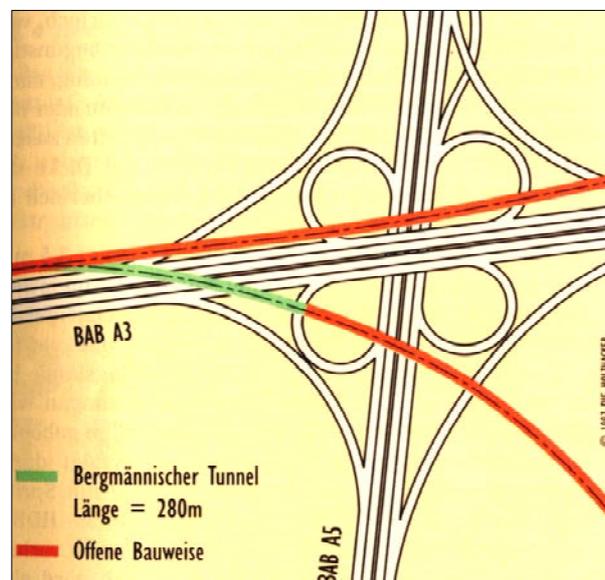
Lageplan der Tunnel unter dem Frankfurter Kreuz [9]
